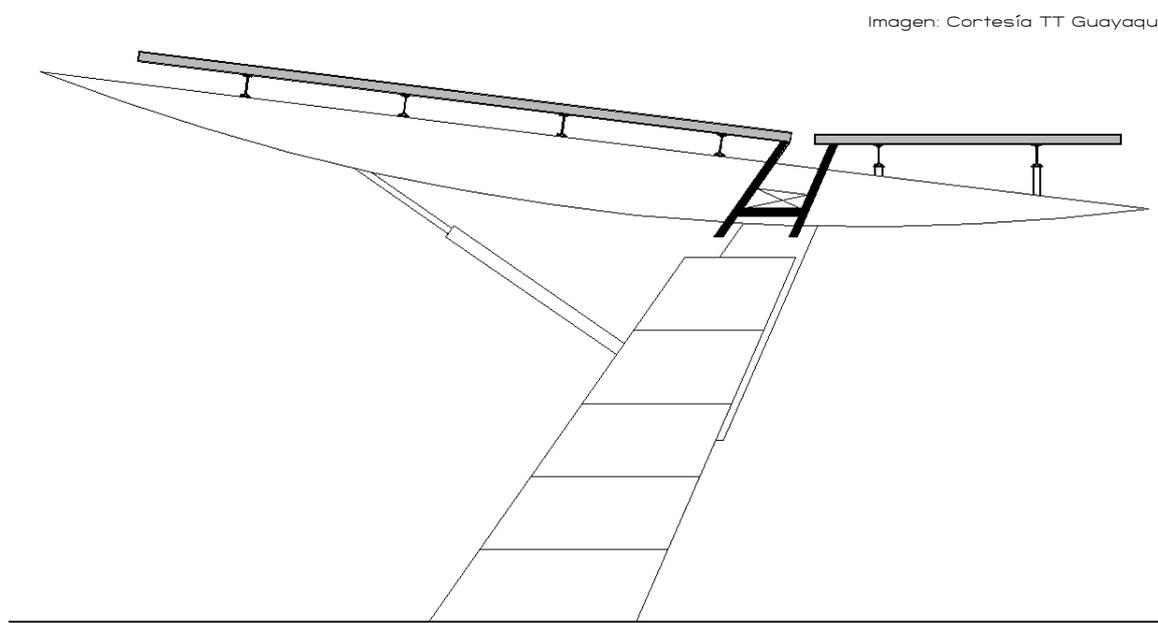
Detalle de la estructura utilizada en el paradero de andenes urbanos
